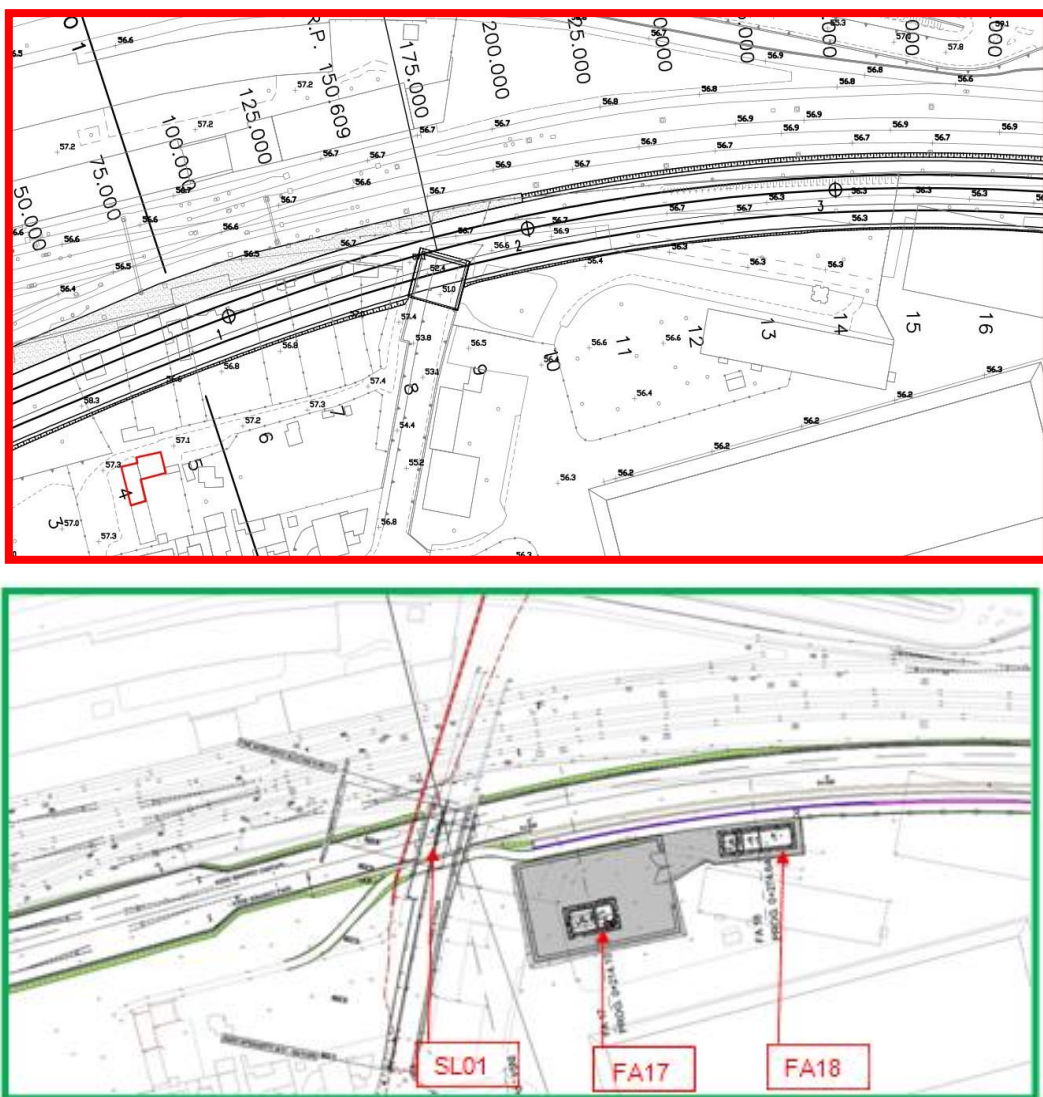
Confronto planimetria PD (rosso) PE (verde)
